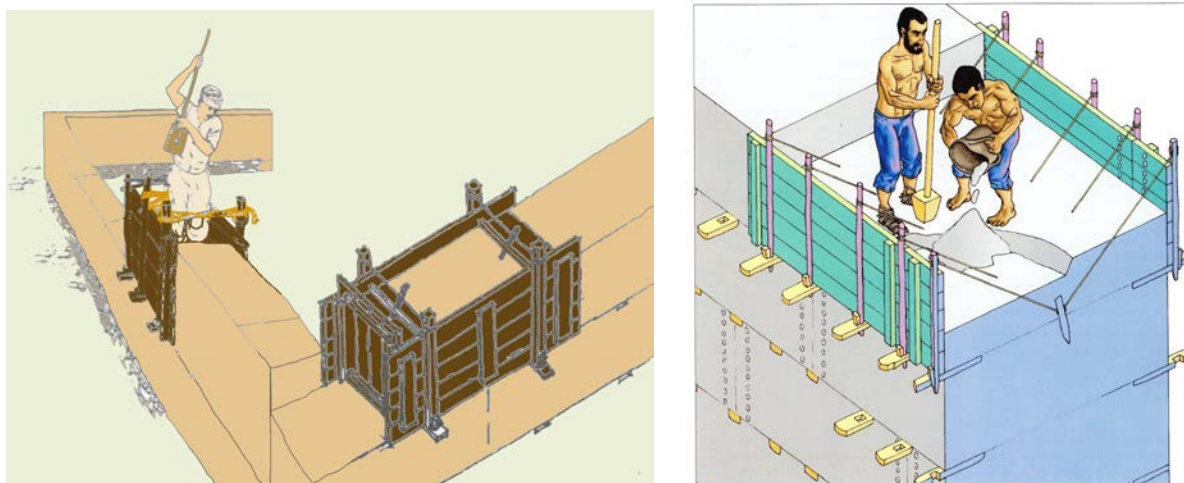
y 173. Construcción de un muro de tapial<sup>755</sup>
